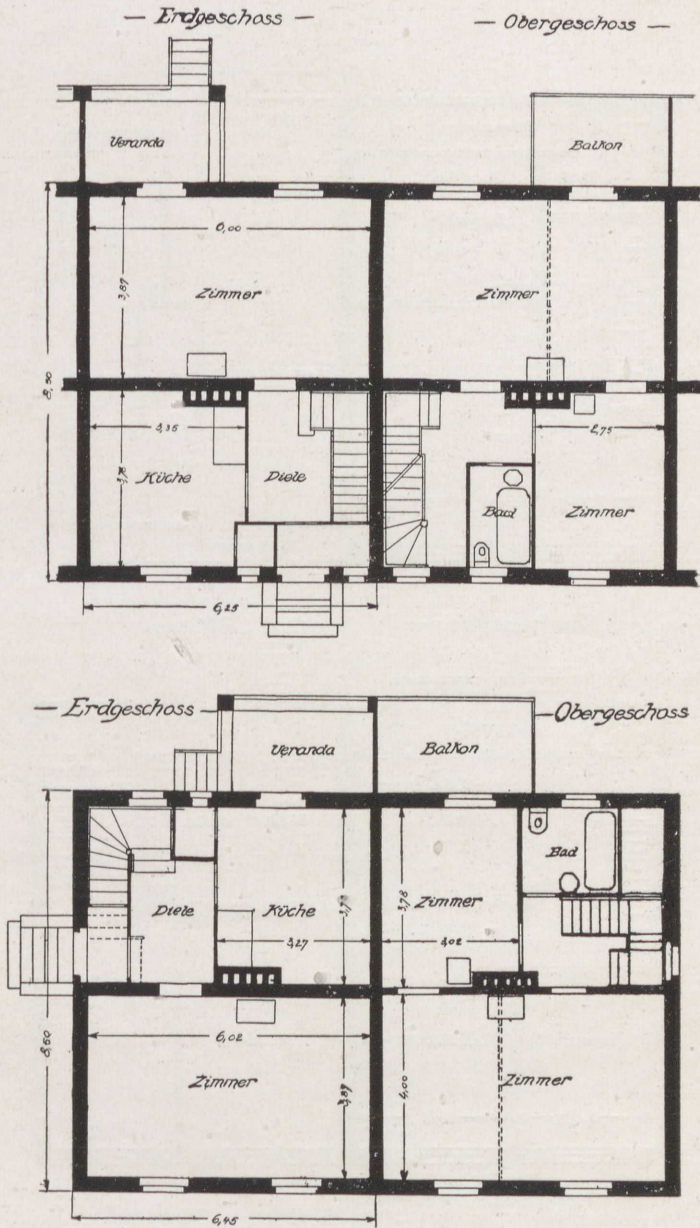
und 6. Typ II u. IIa. Vierräumiges Wohnhaus mit Obergeschoß und Eingang von der Straße bzw. Seite. Größere Wohnfläche, vollständige Unterkellerung und ausreichendes Nebengeläß. Dachgeschoß kann außerdem ausgebaut werden. Stall entweder im Keller, als besonderes Gebäude oder hinter der an Stelle der Veranda anzubauenden Spülküche.
